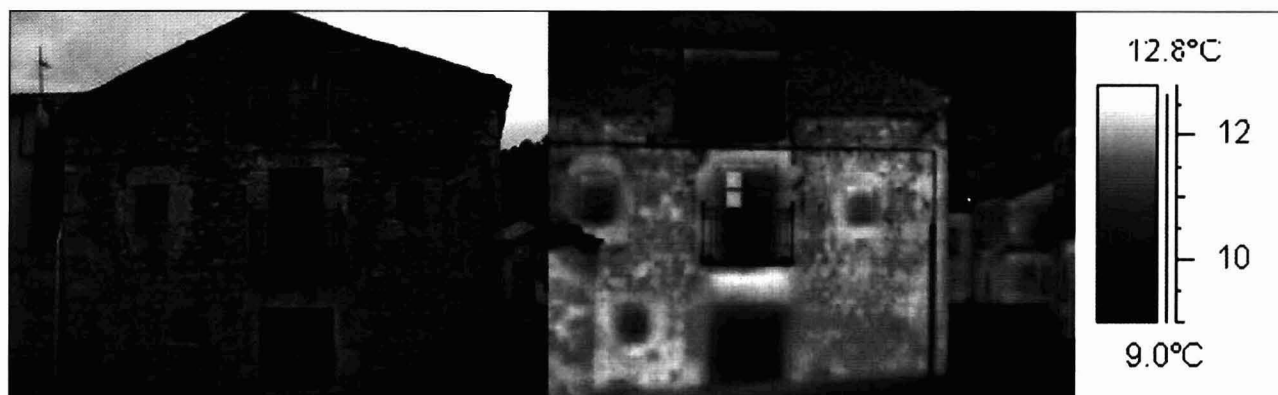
Fachada de una vivienda rural. Las dos primeras plantas están realizadas en mampostería de piedra y la planta de cubierta en adobe. La termografía muestra el diferente comportamiento de estos materiales. Tomada al anochecer.
